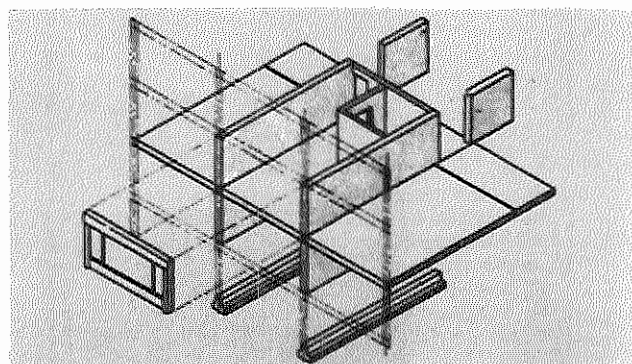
Painel – “painéis de concreto armado pré-moldado ‘in loco’ de metal, madeira ou plástico, com outros componentes embutidos. Os painéis podem, ser estruturais ou não.”
